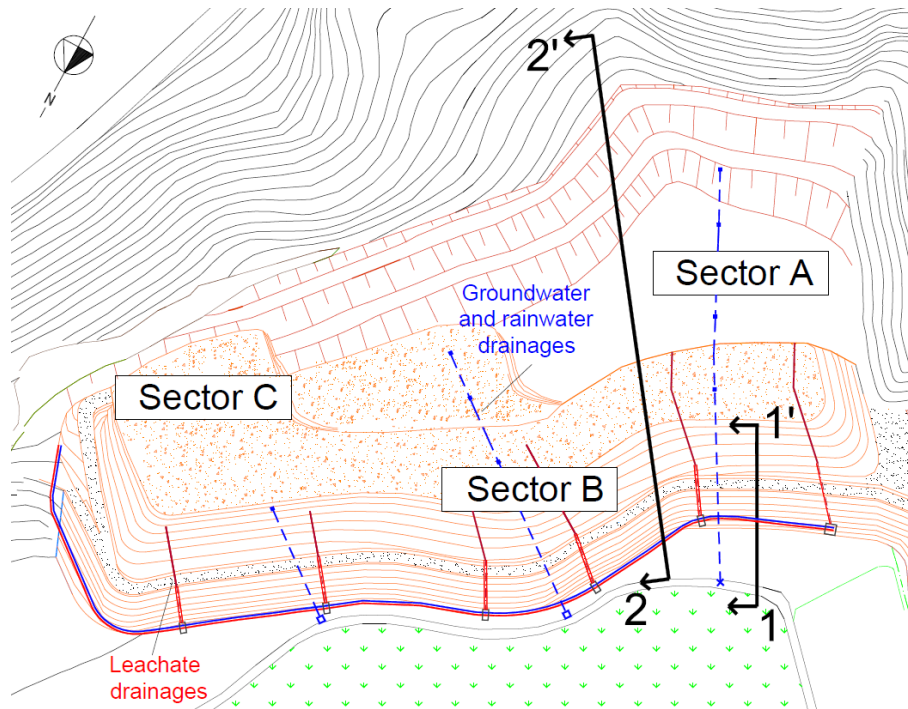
Vista planimetrica della *Discarica A*.
